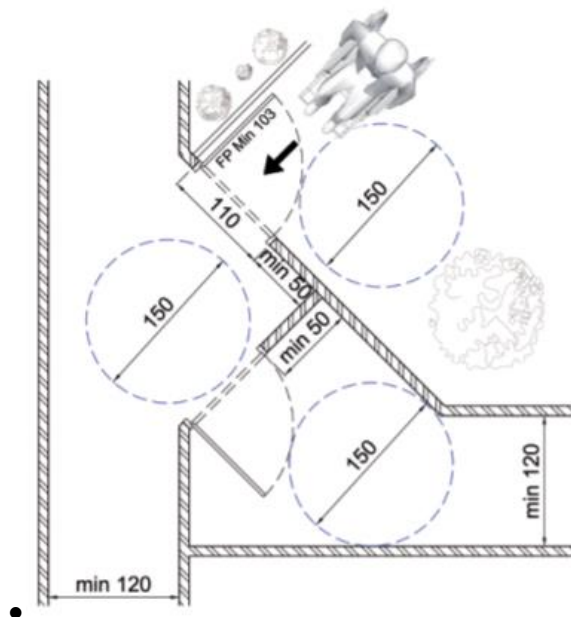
Conception d'une porte d'accès accessible pour tous, Source : Guide d'aide à la construction d'un bâtiment accessible
